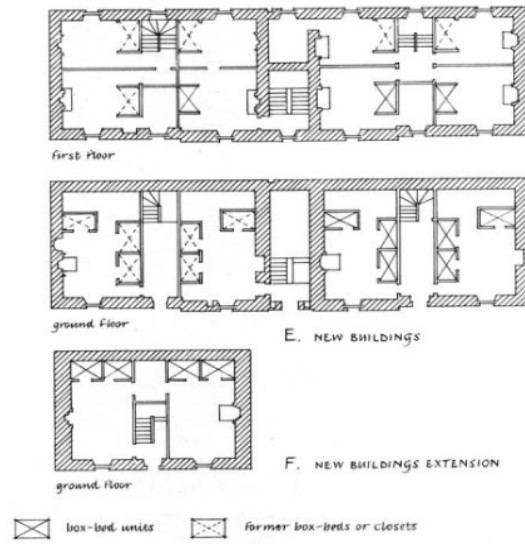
Baumwollspinnerei, New Lanark, Schottland, Grundriss von Arbeiterwohnungen innerhalb eines Reihenhauses
